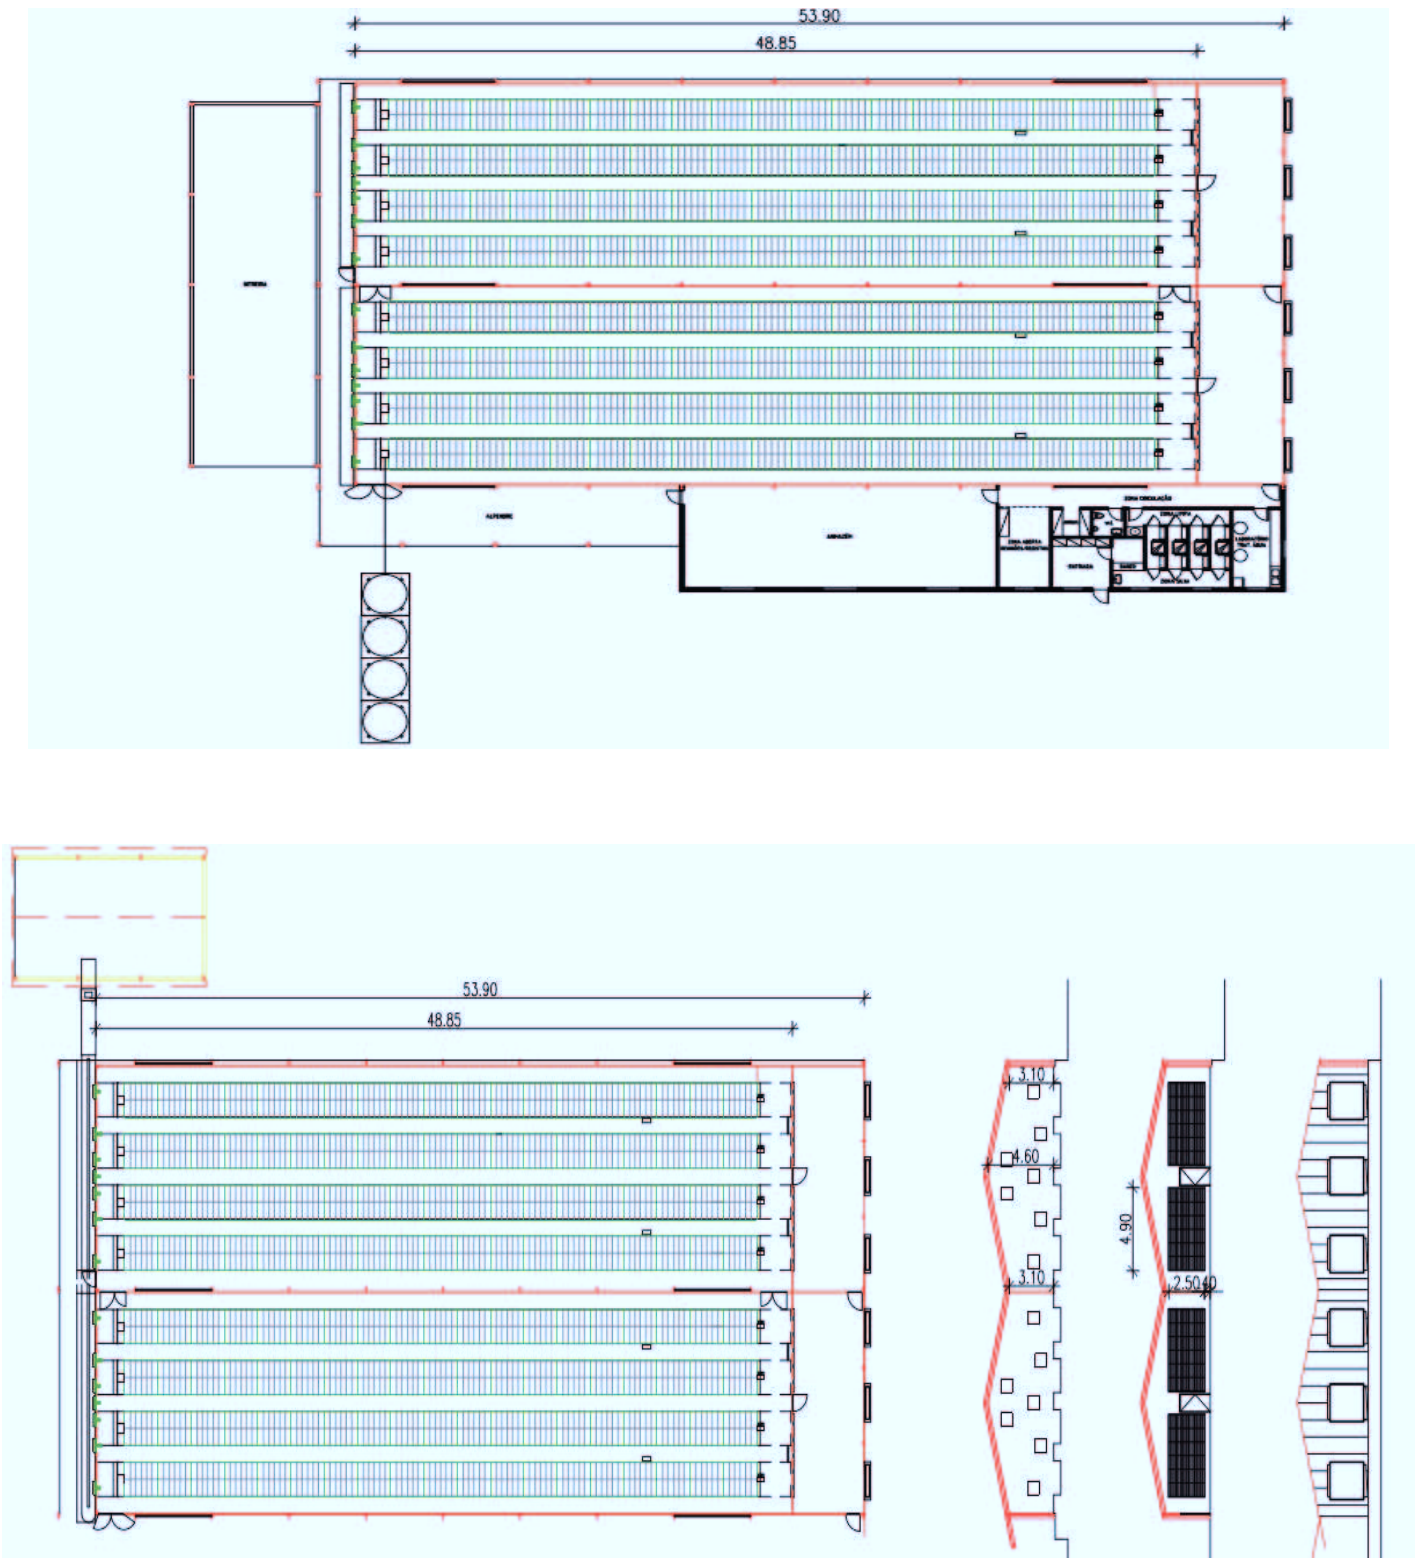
Planta e alçados das instalações (Projeto de arquitetura)
